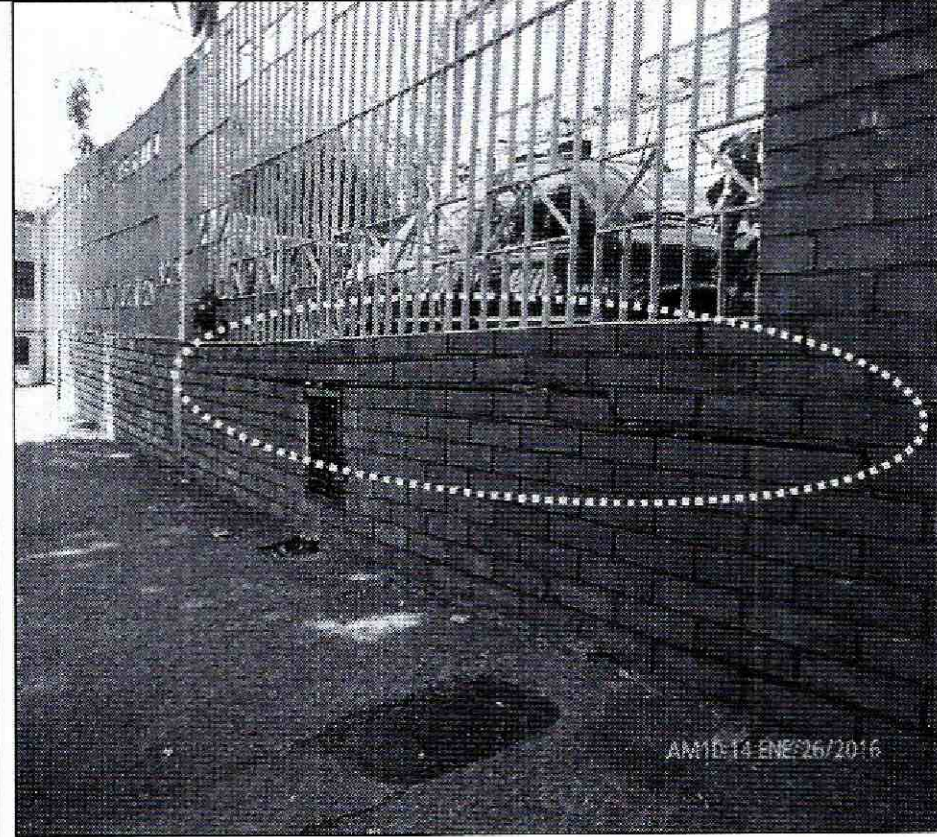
Fractura de tendencia diagonal en muro de fachada del segundo nivel de la vivienda de la Carrera 70 A No. 123 - 03 en el Sector Catastral Niza Sur de la Localidad Suba.
